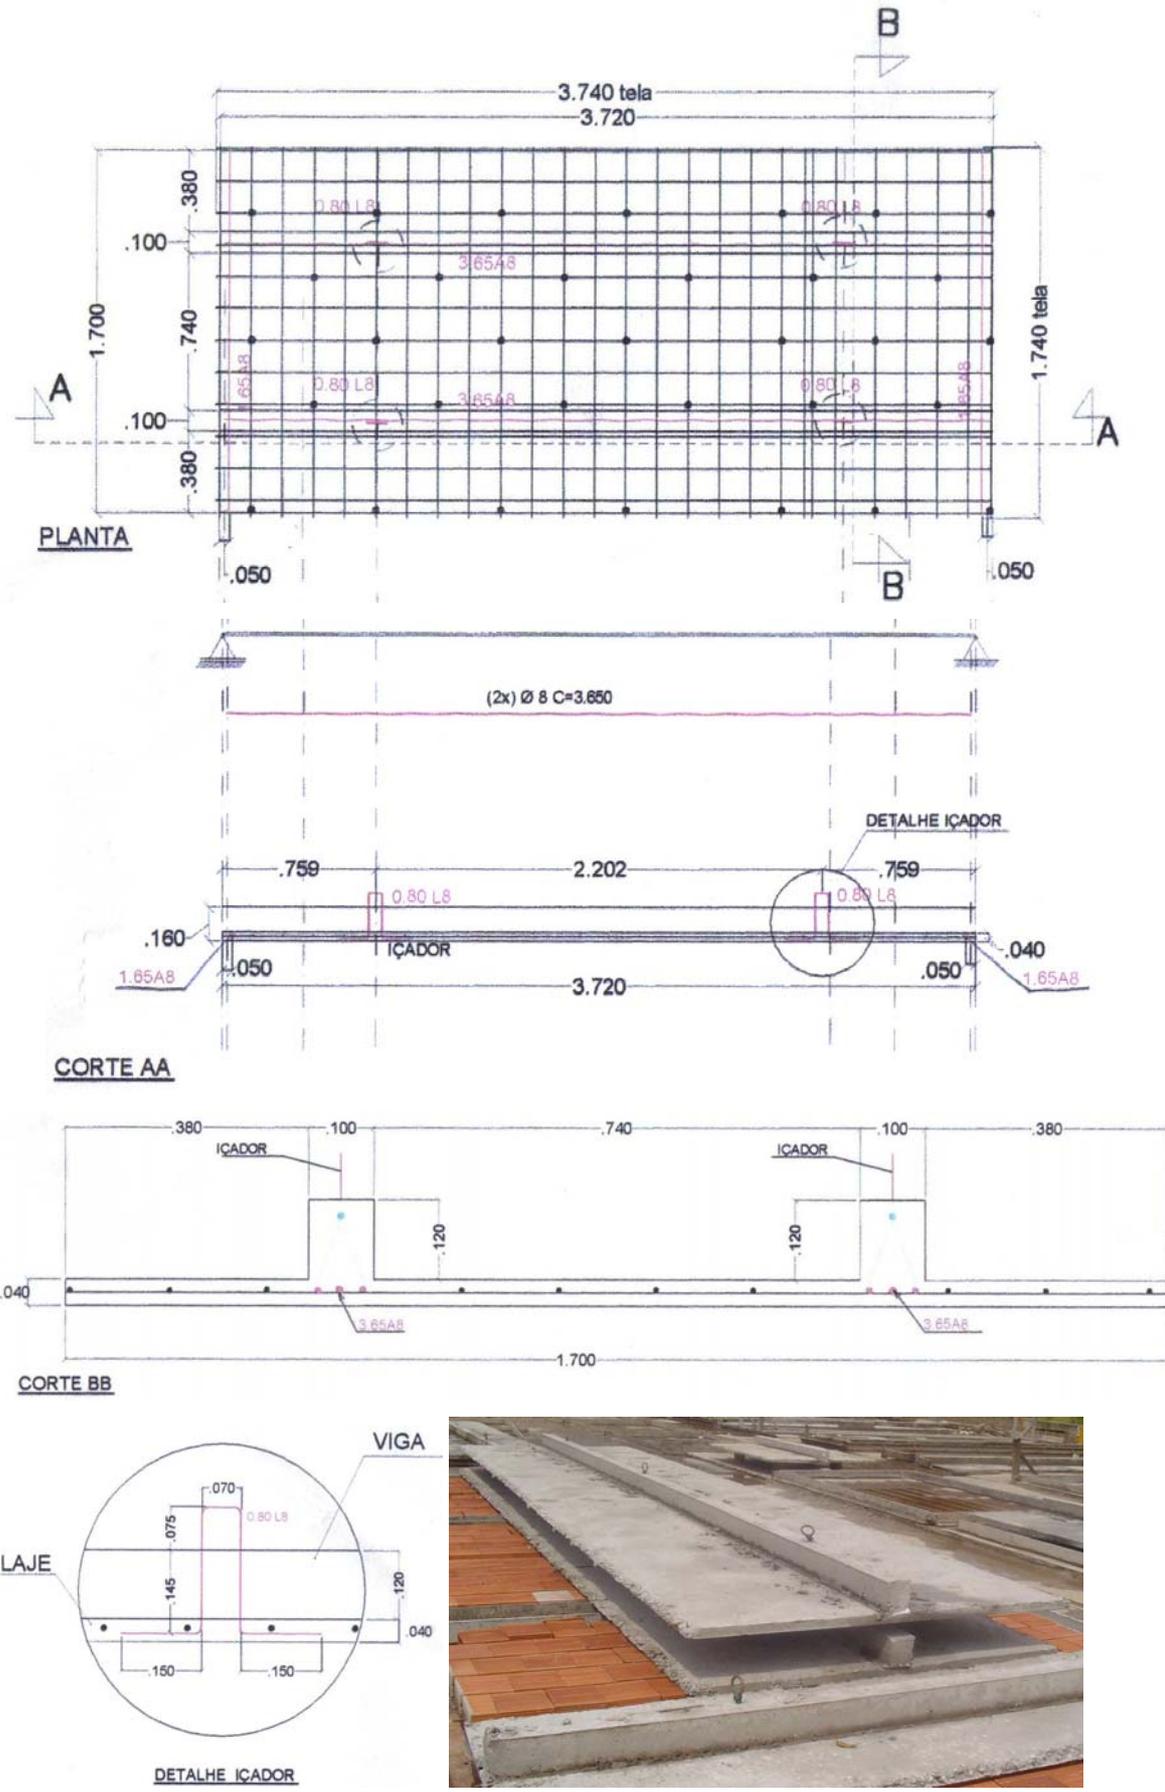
Detalhe da laje pré-fabricada Jet Casa
